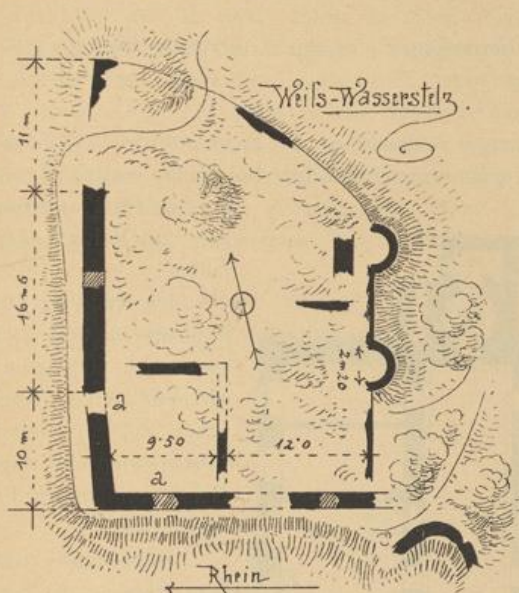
Weisswasserstels. Grundriss der Burg. II.
